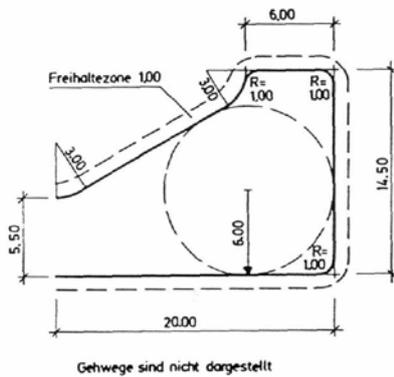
Wendehammer für Lastkraftwagen bis 10,00 m Länge (3-achsiges Müllfahrzeug, Lkw 22,0 t) mit Wendekreis für Personenkraftwagen (Wendeanlagentyp 3)
